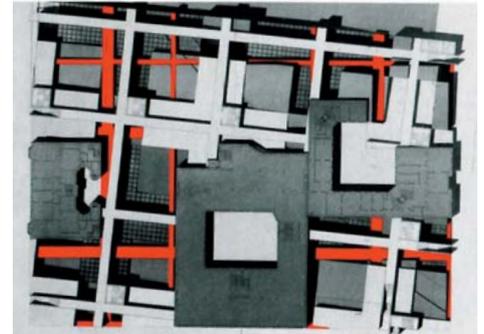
Grundriss Wettbewerbsentwurf ‚IBA Block5‘
